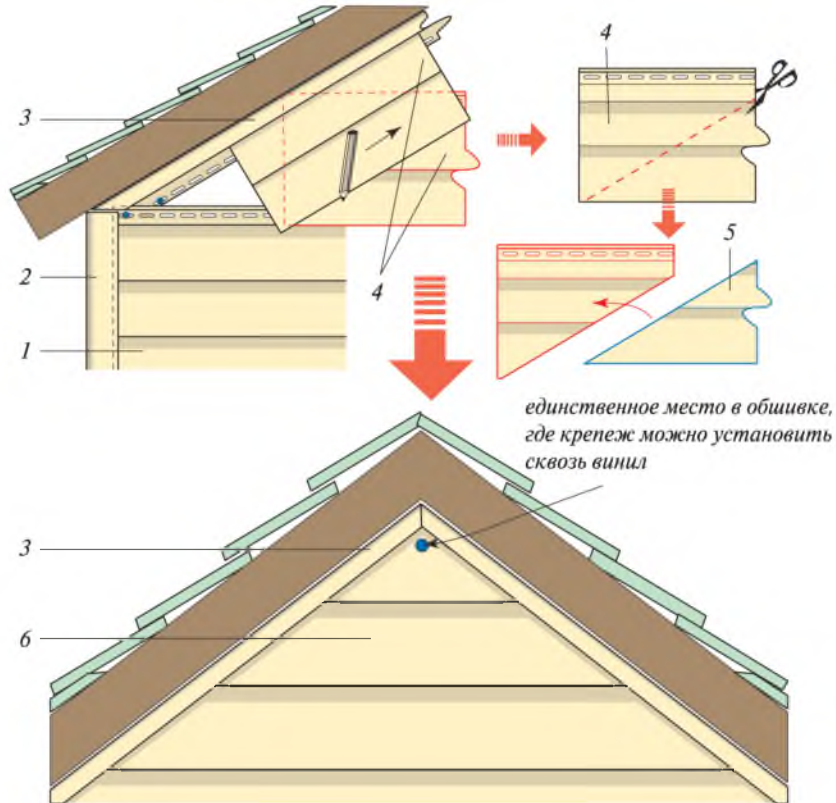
Изготовление шаблона и установка сайдинга на фронтоне: 1 — рядовой сайдинг; 2 — угловой профиль; 3 — J или угловой профиль; 4 — обрезок рядовой панели; 5 — шаблон; 6 — обшивка фронтона
